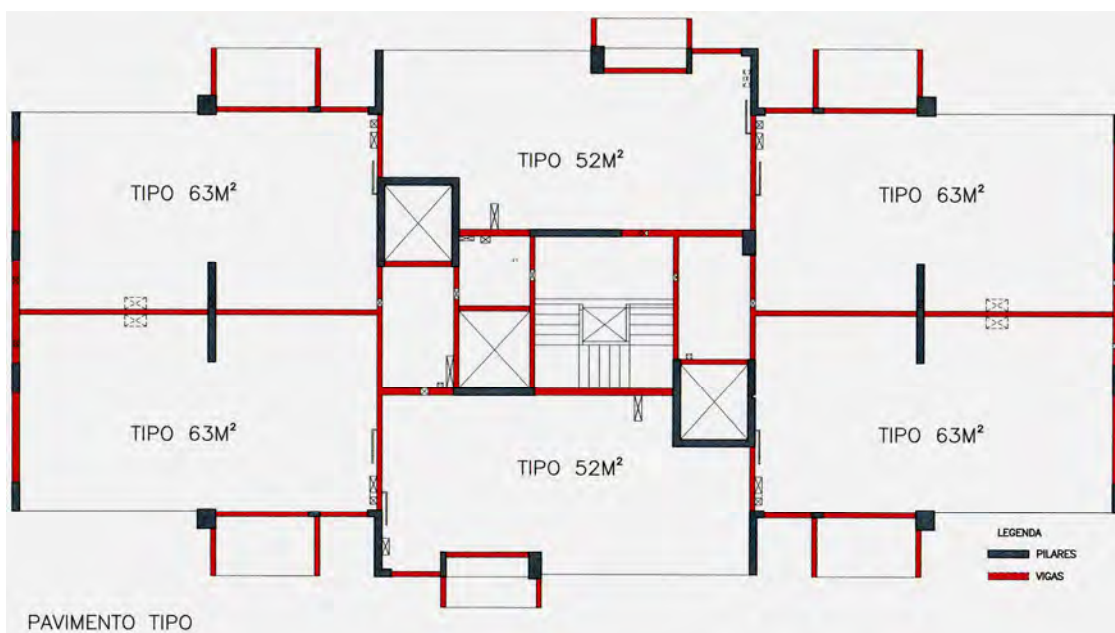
Forma do pavimento tipo. Em cinza os pilares e em vermelho as vigas.
